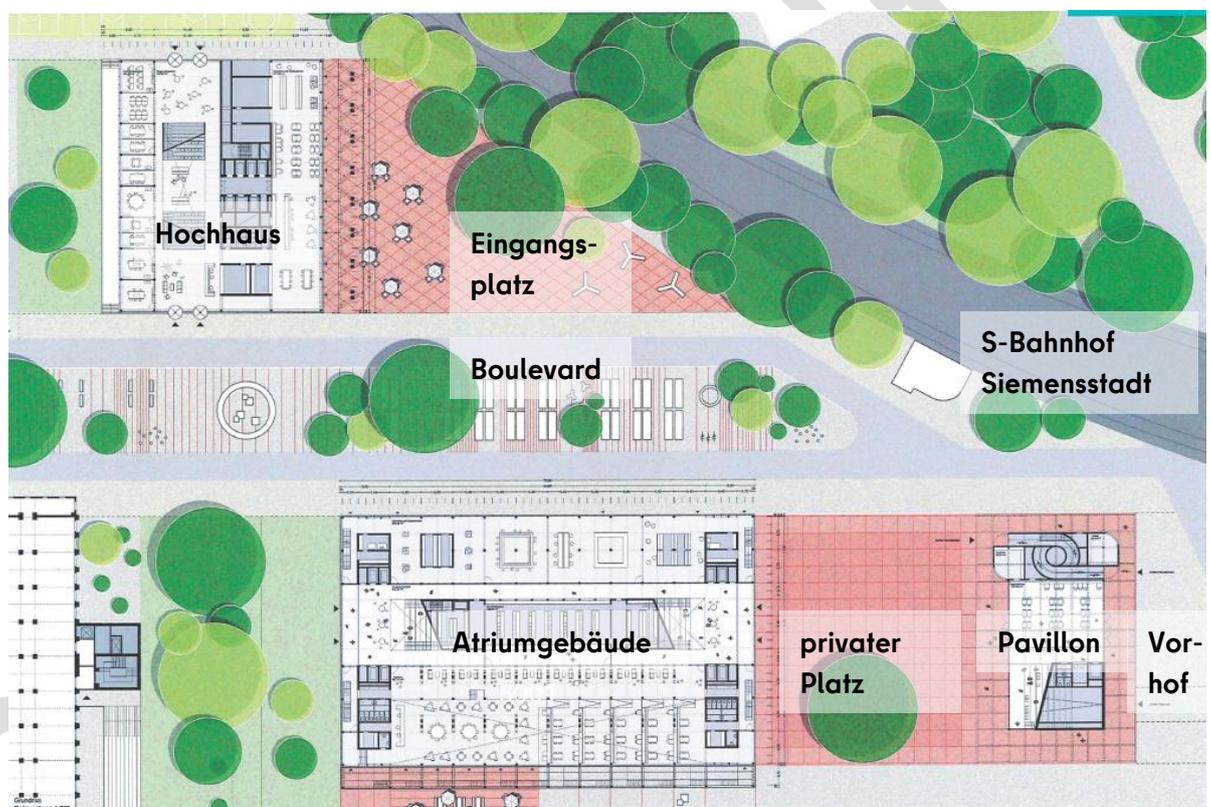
ROBERTNEUN™: Wettbewerbsbeitrag 6001, Siemensstadt 2.0, Lageplan Erdgeschoss, November 2020. Ergänzung GfP: Eintragung der in der Begründung verwendeten Bezeichnungen.
